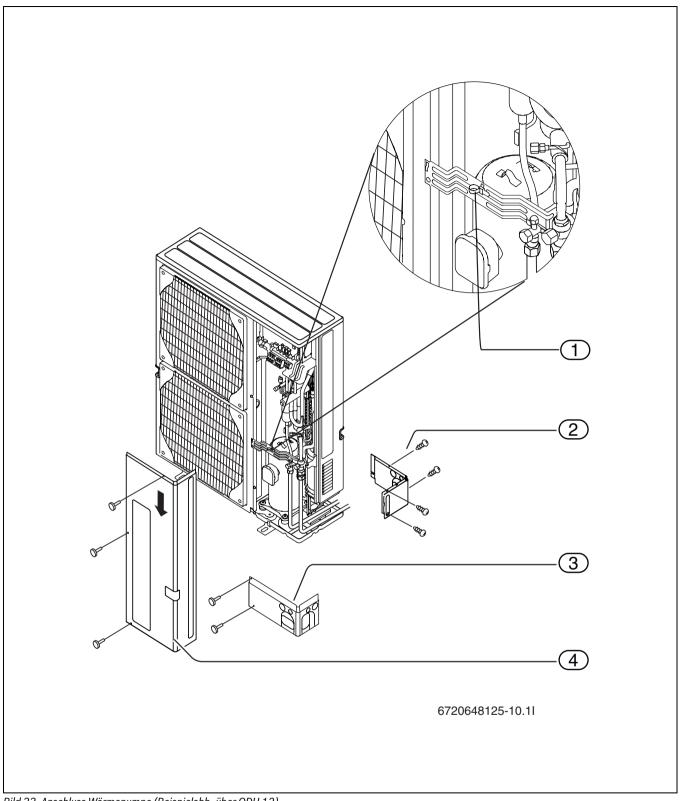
Anschluss Wärmepumpe (Beispielabb. über ODU 12)
